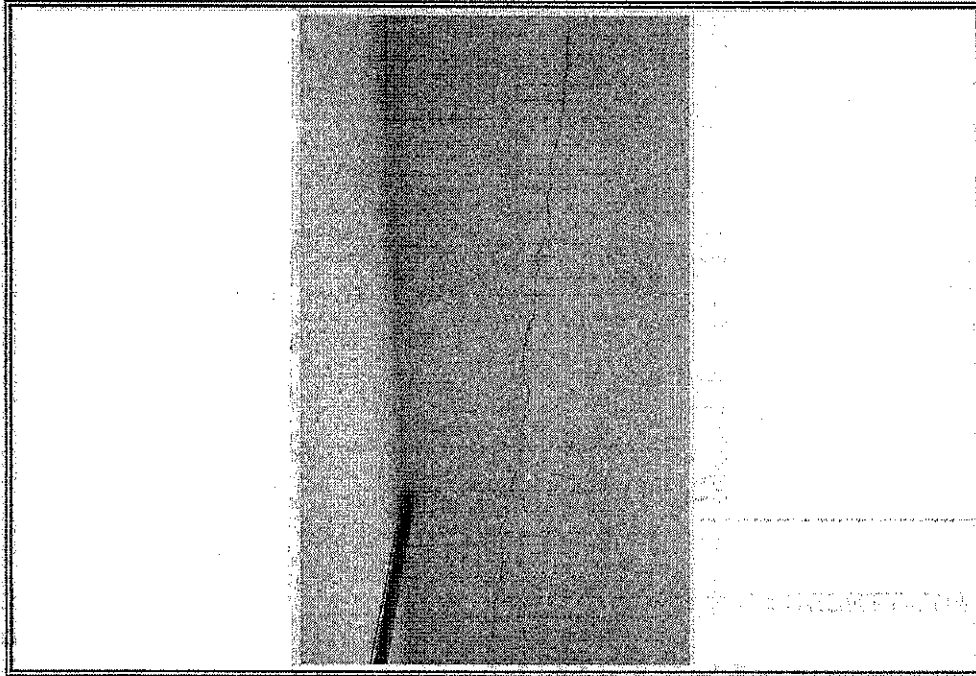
Fissura na laje-ALTO FELIZ
